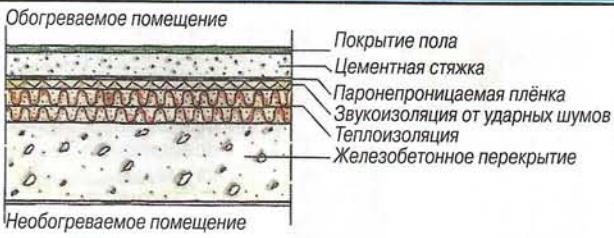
Теплоизоляция перекрытия обеспечивает быстрый нагрев помещения.
